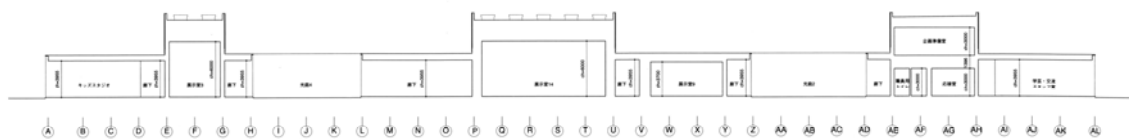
Corte Norte Sul em direção ao Oeste.
